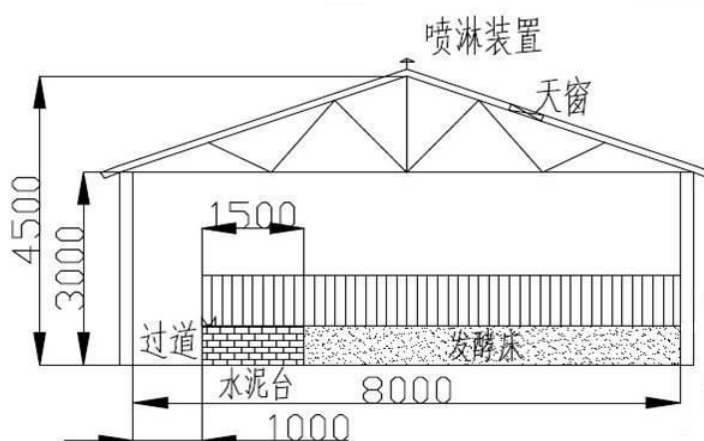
单列式室内发酵床猪舍剖面示意图（单位：mm）
